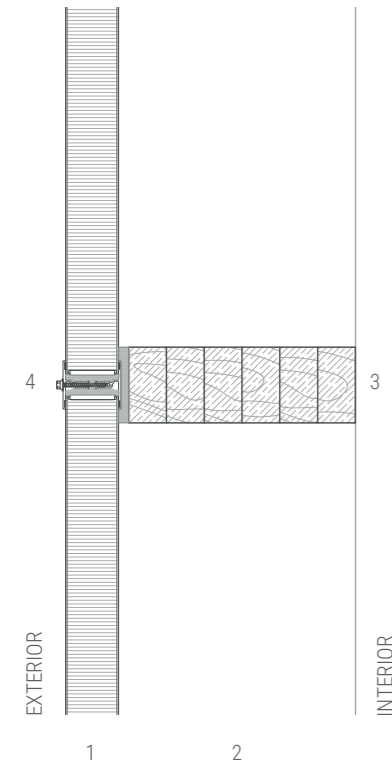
Detalle [cerramiento traslúcido] E1:10
